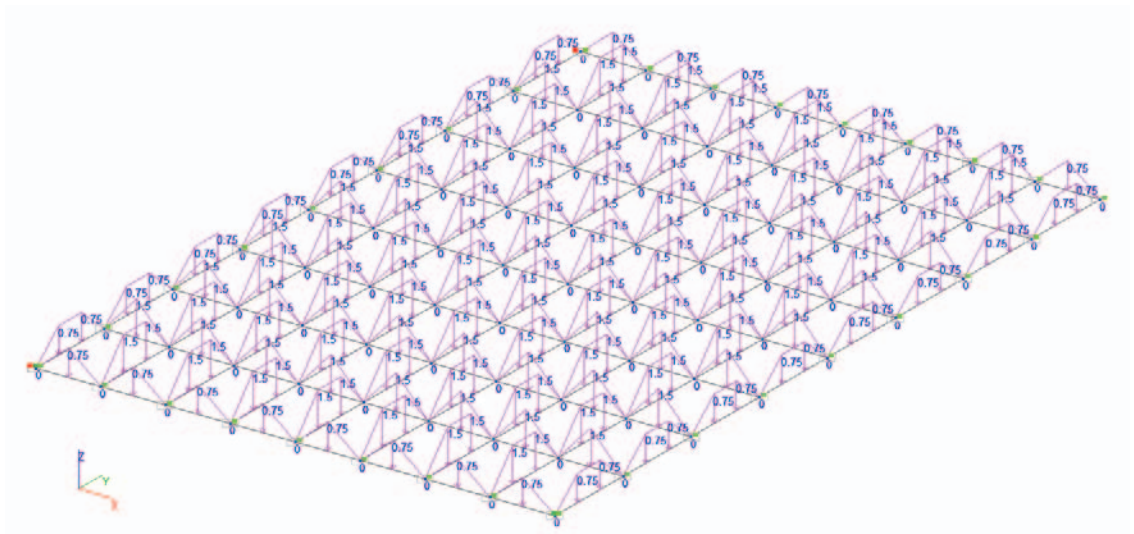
Расчетная модель SCAD перекрытия размером в плане $[L_x \times L_y]$ 12,0 × 18,0 м с кессонами 1,5 × 2,25 м
